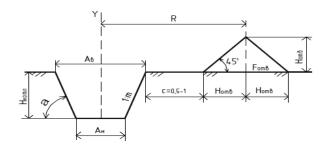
Поперечный разрез котлована и отвала грунта
